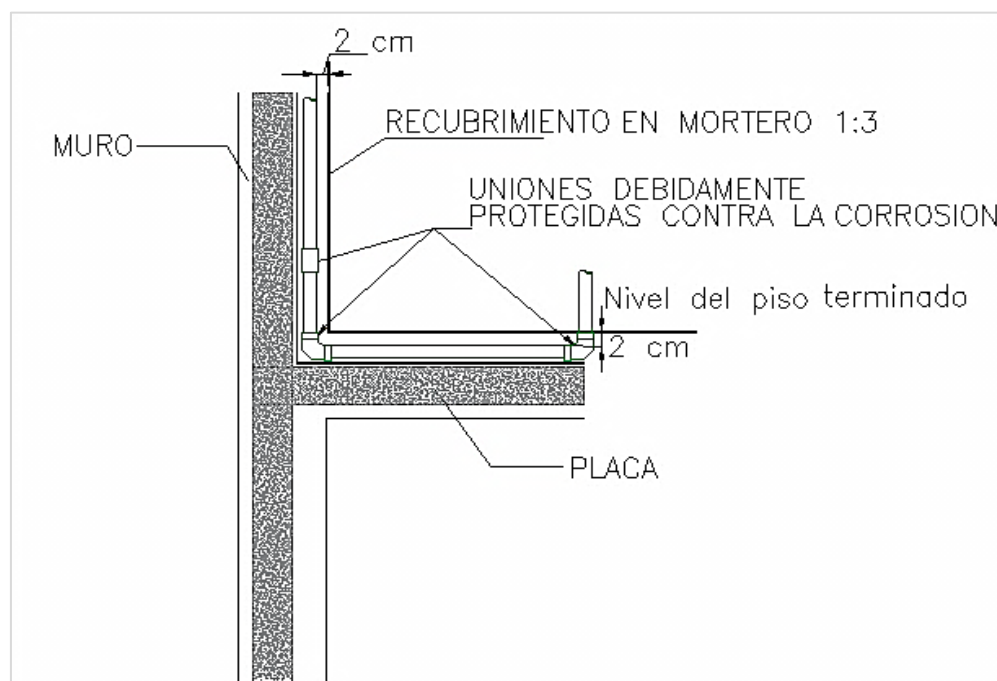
Disposición tubería por afinado de piso. Elaboración propia
